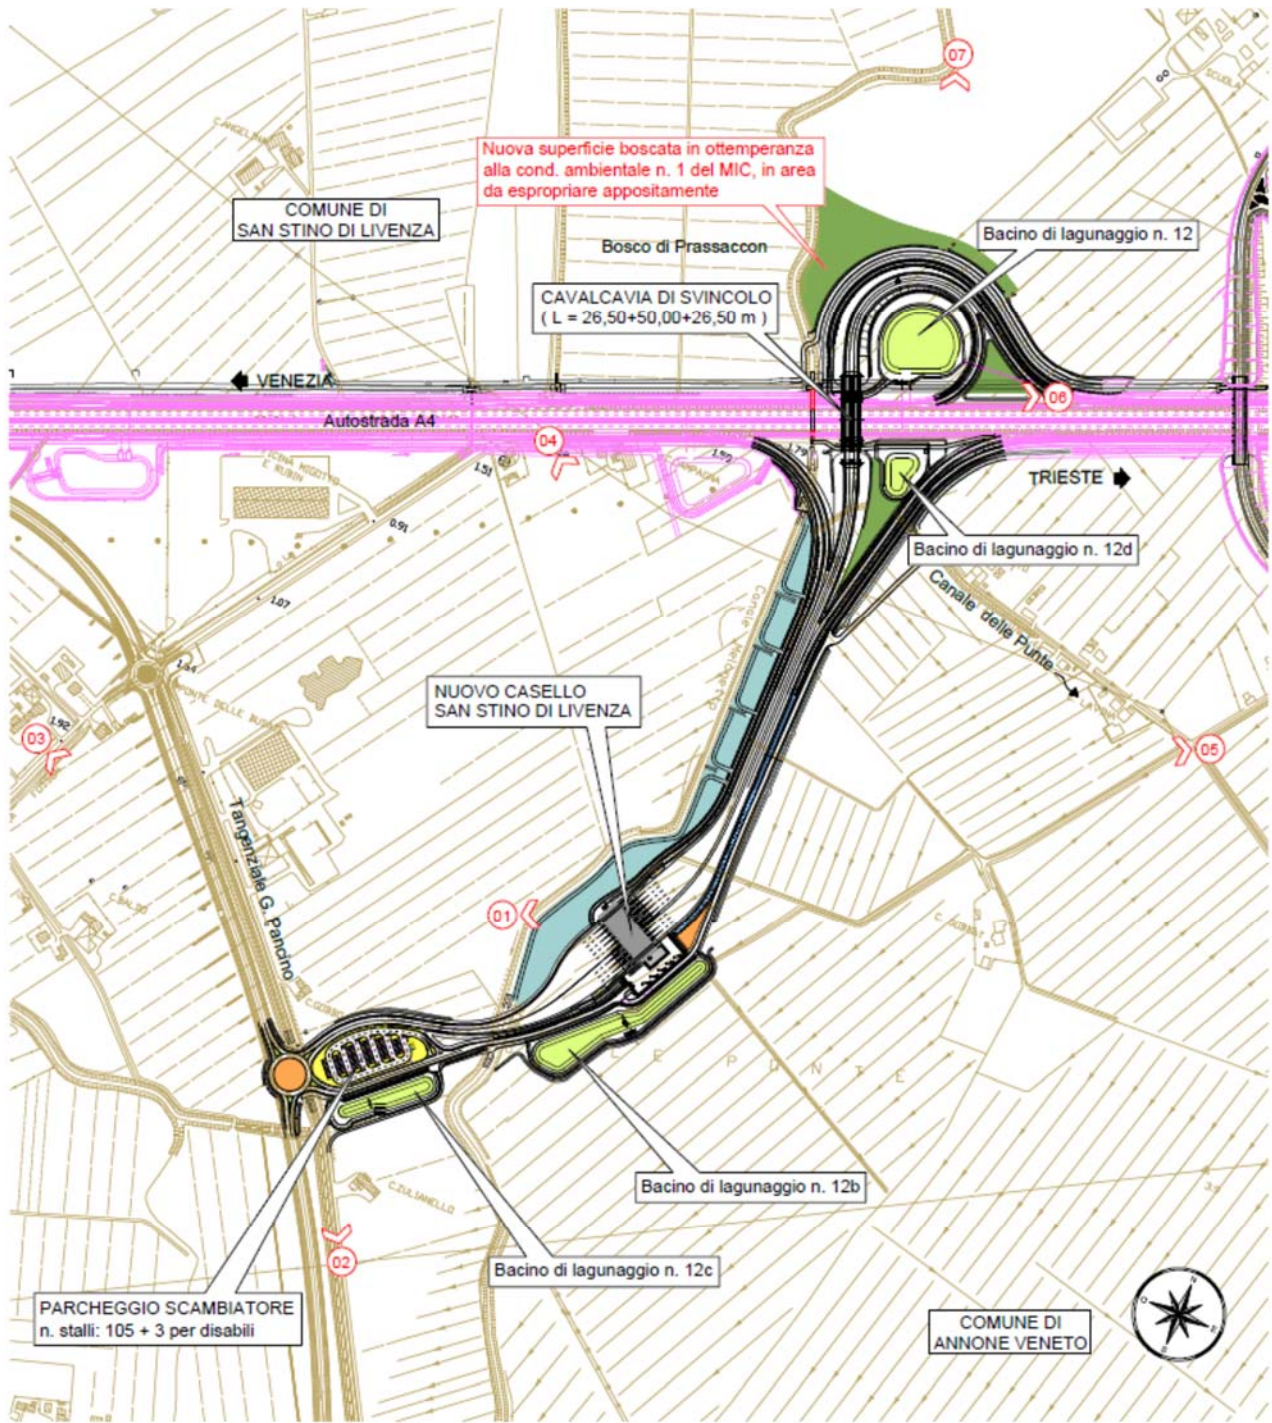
estratto della planimetria delle opere a verde con la composizione delle tipologie
